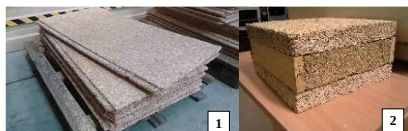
Panouri prefabricate din beton de cânepă [83], [84]
